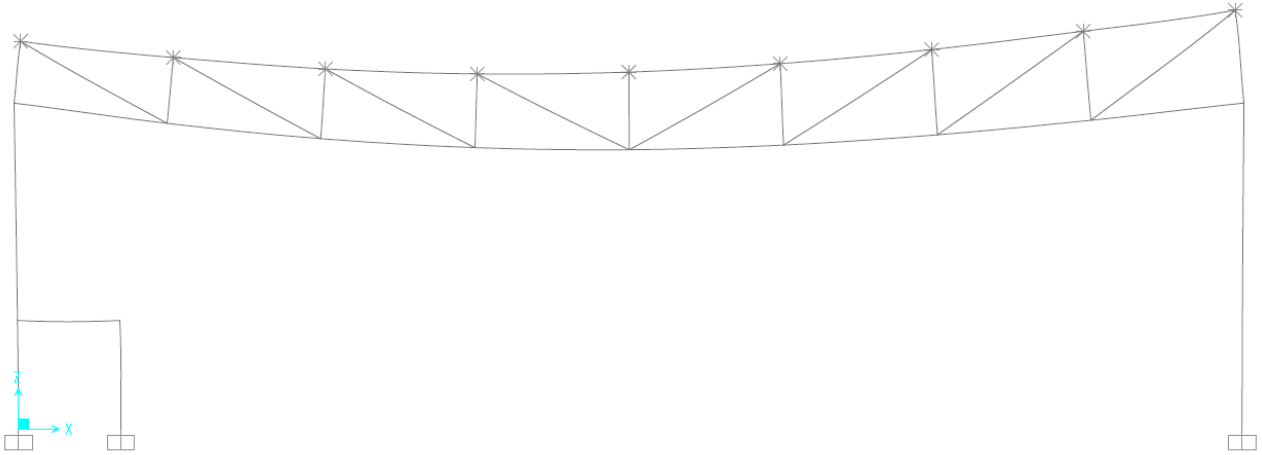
PÓRTICO 4 – DEFORMADA ELStab
